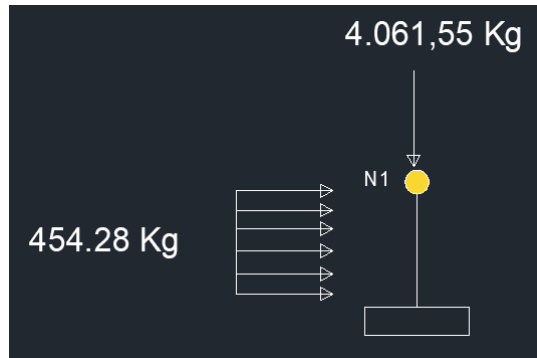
Esfuerzos sometidos al pilar. Fuente: Elaboración propia
